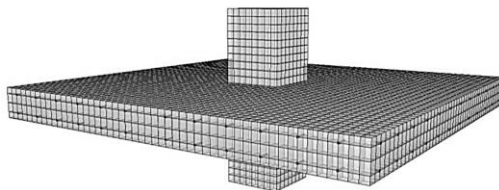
Модель узла сопряжения колонны и плиты перекрытия
